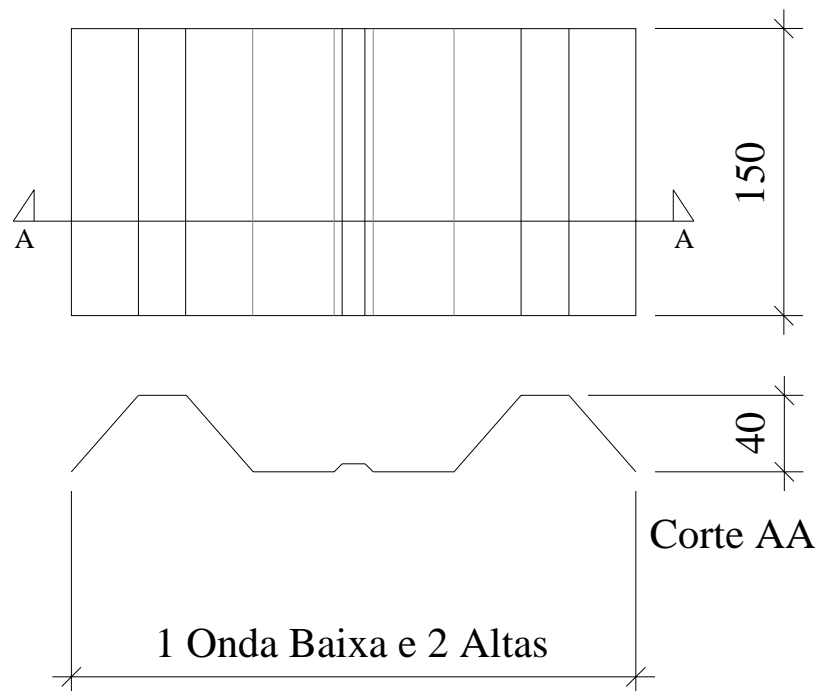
Pedaço de telha para ensaio. (unidades em mm)
